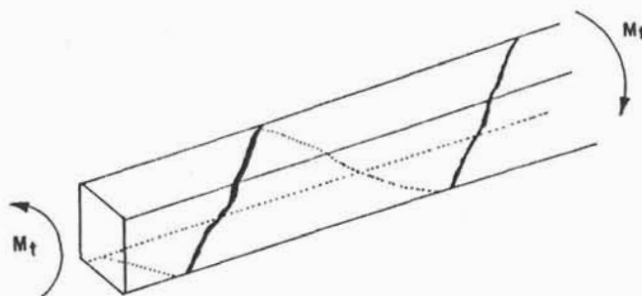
Fissuras em viga solicitada à torção
